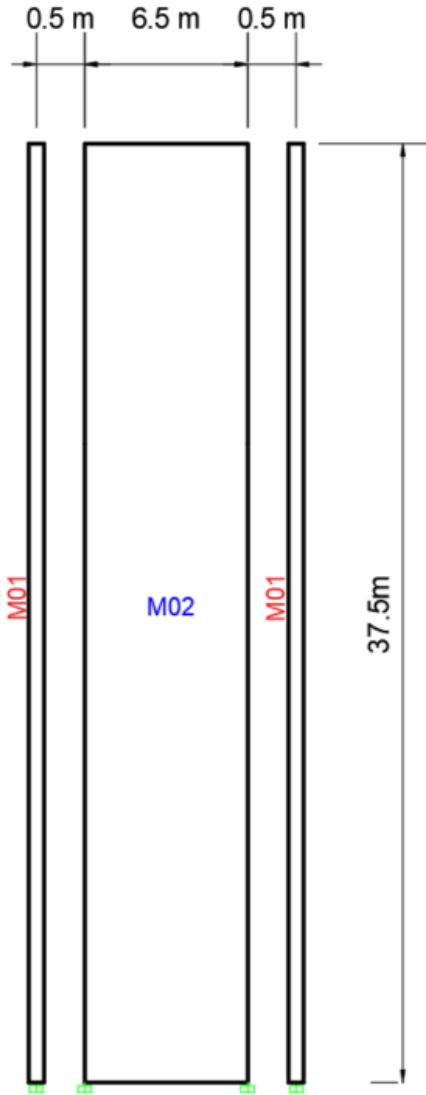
Elevación Eje 3' Edificio 12 Pisos.
